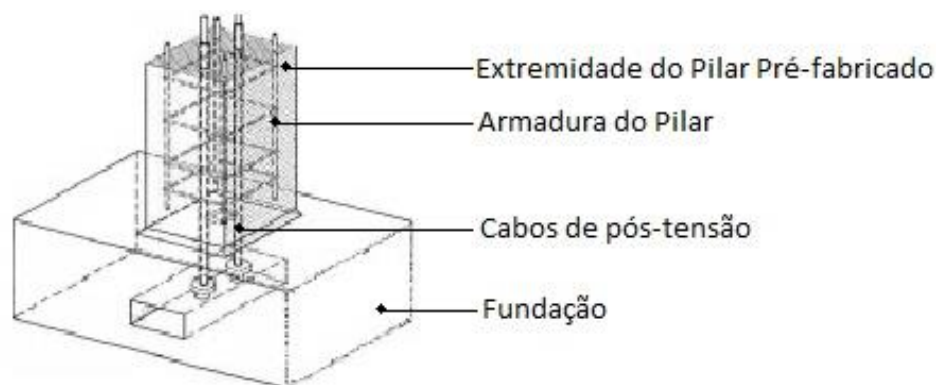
Ligação Pilar – Fundação por pós-tensão [46]
